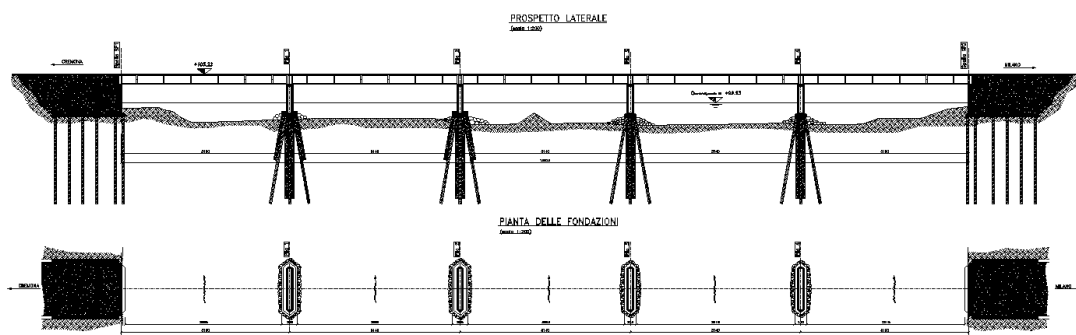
Prospetto e pianta del ponte sul fiume Adda in Comune di Rivolta d'Adda
